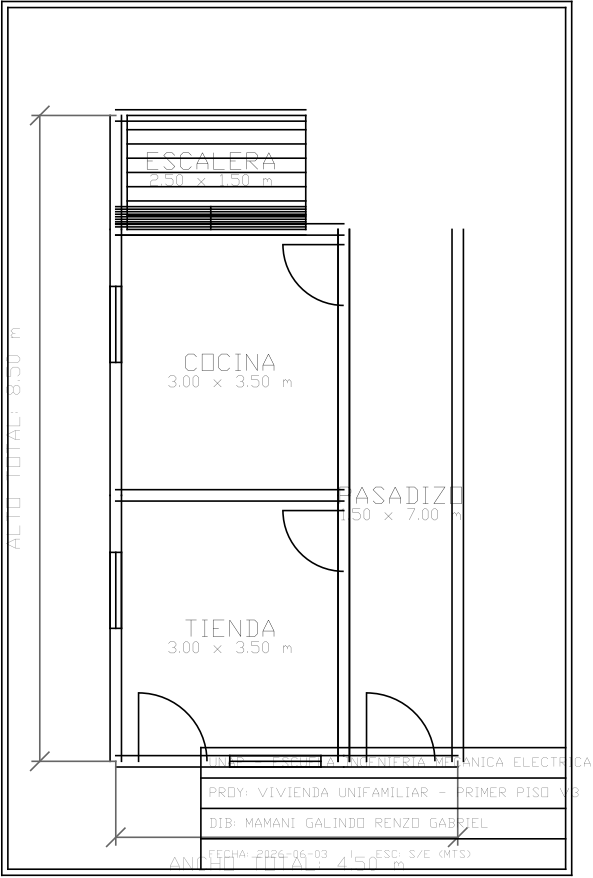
Plano de Distribución Arquitectónica - Primer Piso
